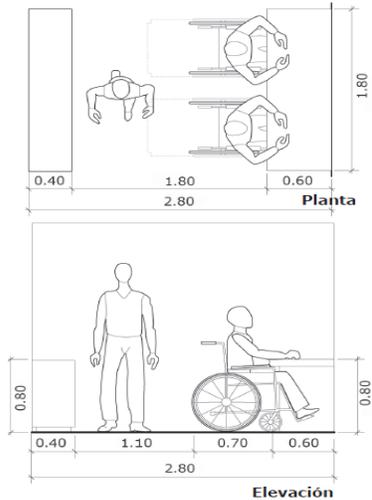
Planta y elevación de área de estudio, CONADI, 146.
